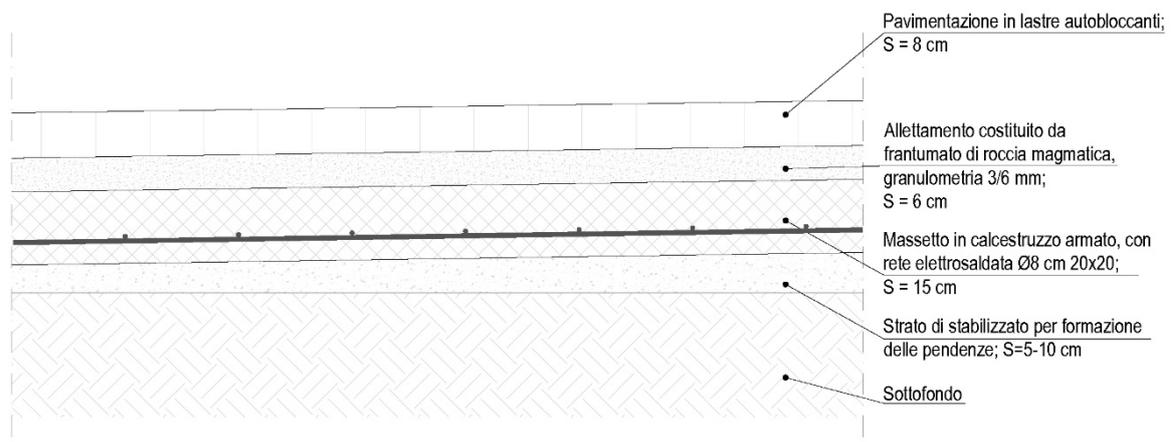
Pacchetto stradale in lastre autobloccanti di progetto
